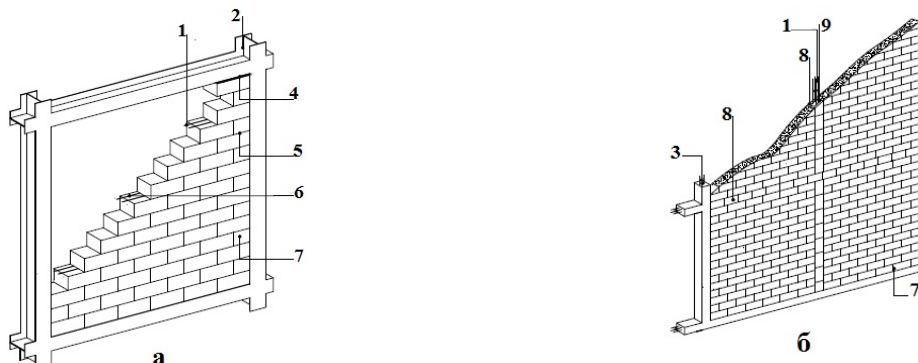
Вариант заполнения несущего каркаса блоками: а — каркас металлический; б — каркас железобетонный; 1 — арматурный стержень Ø 8–12 мм; 2 — несущий каркас металлический; 3 — несущий каркас железобетонный; 4 — заполнение монтажной пеной; 5 — клеевой шов 1–3 мм; 6 — заполнение раствором; 7 — блоки YTONG; 8 — U-образные блоки; 9 — бетон
